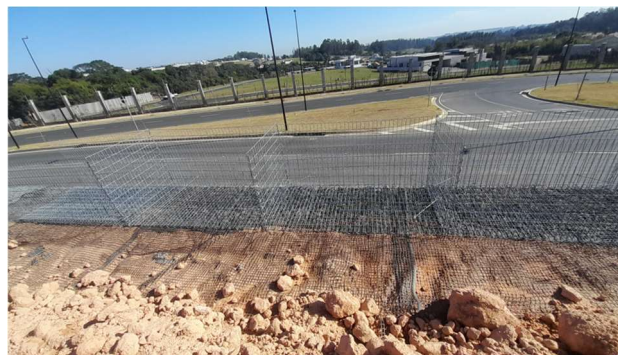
União dos gabiões de malha soldada com conexões em espiral
